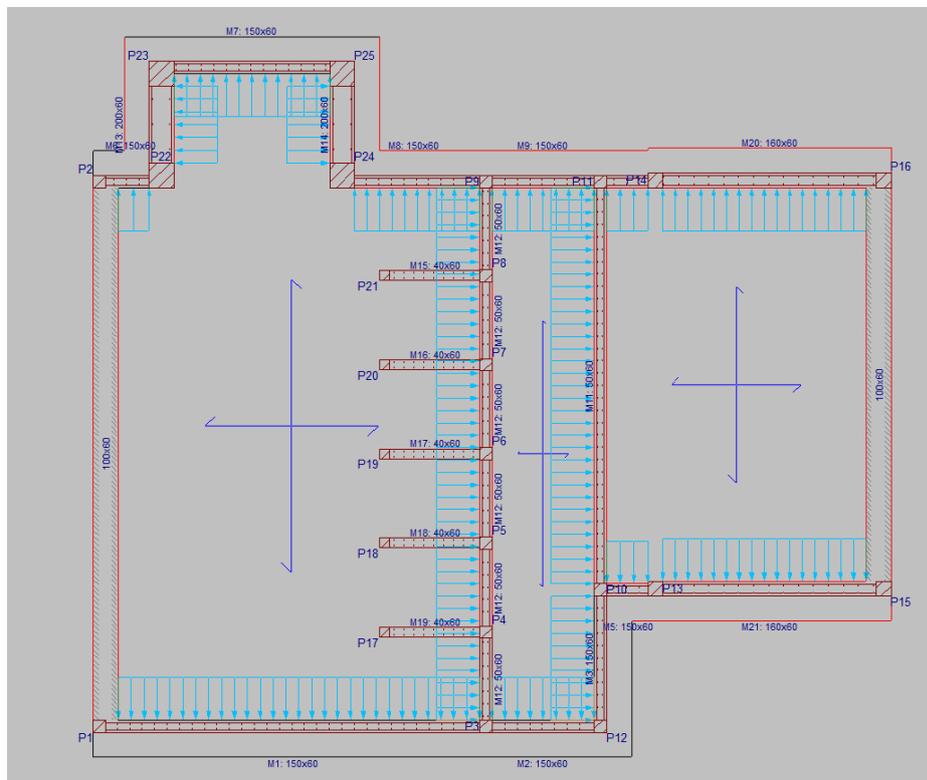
Vista de planta de la almenara, con los empujes de agua sobre muros sin los rellenos terminados.
